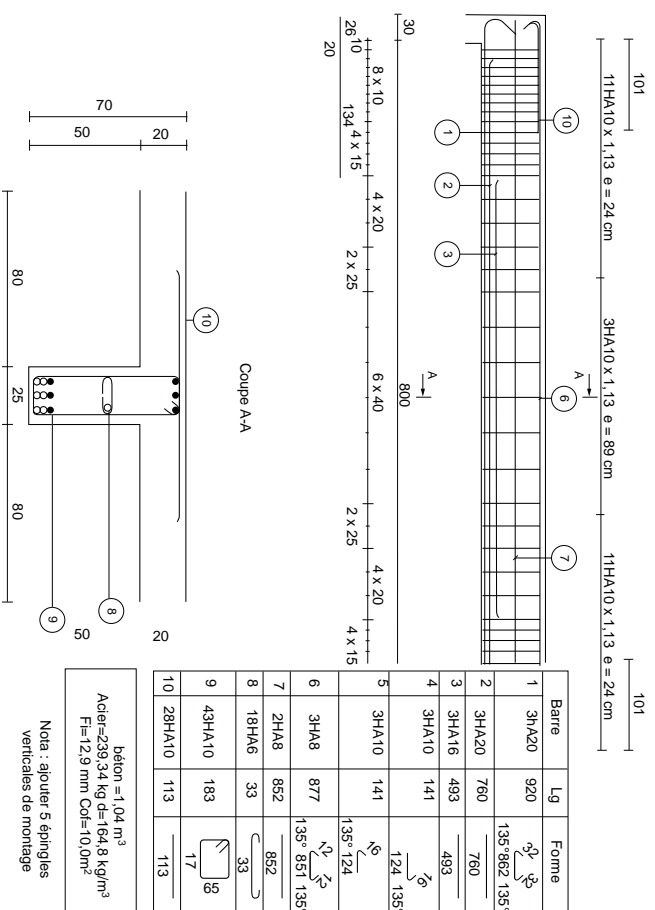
B : ferrillage de poutre, exemple de sortie d'ordinateur, variante.
